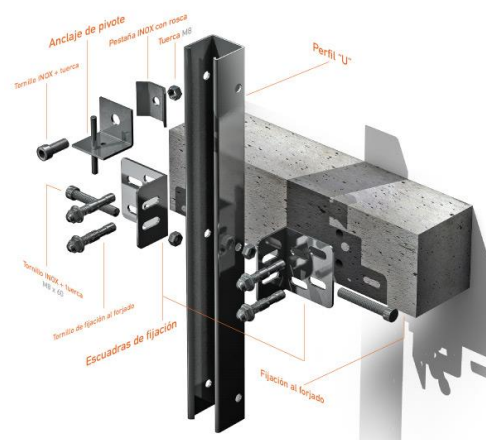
Ejemplo de sujeción de fachada ventilada con perfil vertical. Fuente: Gutterkel (2014)
